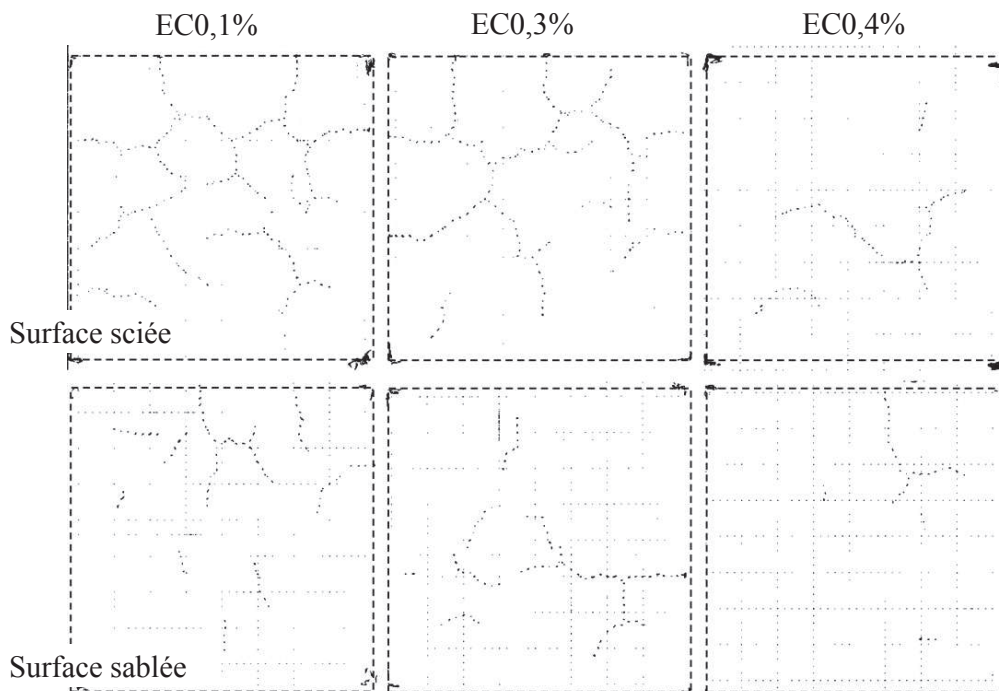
Impact du dosage en éther de cellulose sur la fissuration à la surface séchant du mortier dans le cas d'un support scié et d'un support sablé (1-2mm) 29 jour après le décoffrage (observation par fissuromètre optique)
